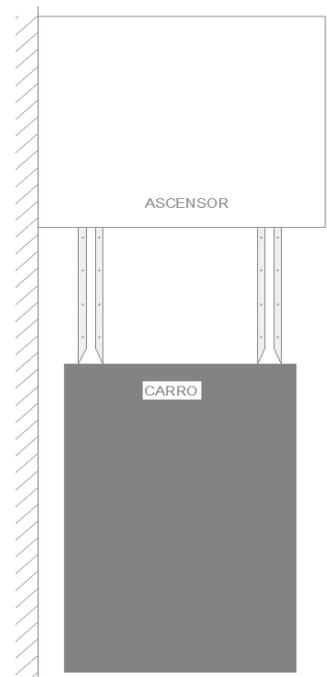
Vista en planta de raíles instalados en la entrada del ascensor.
